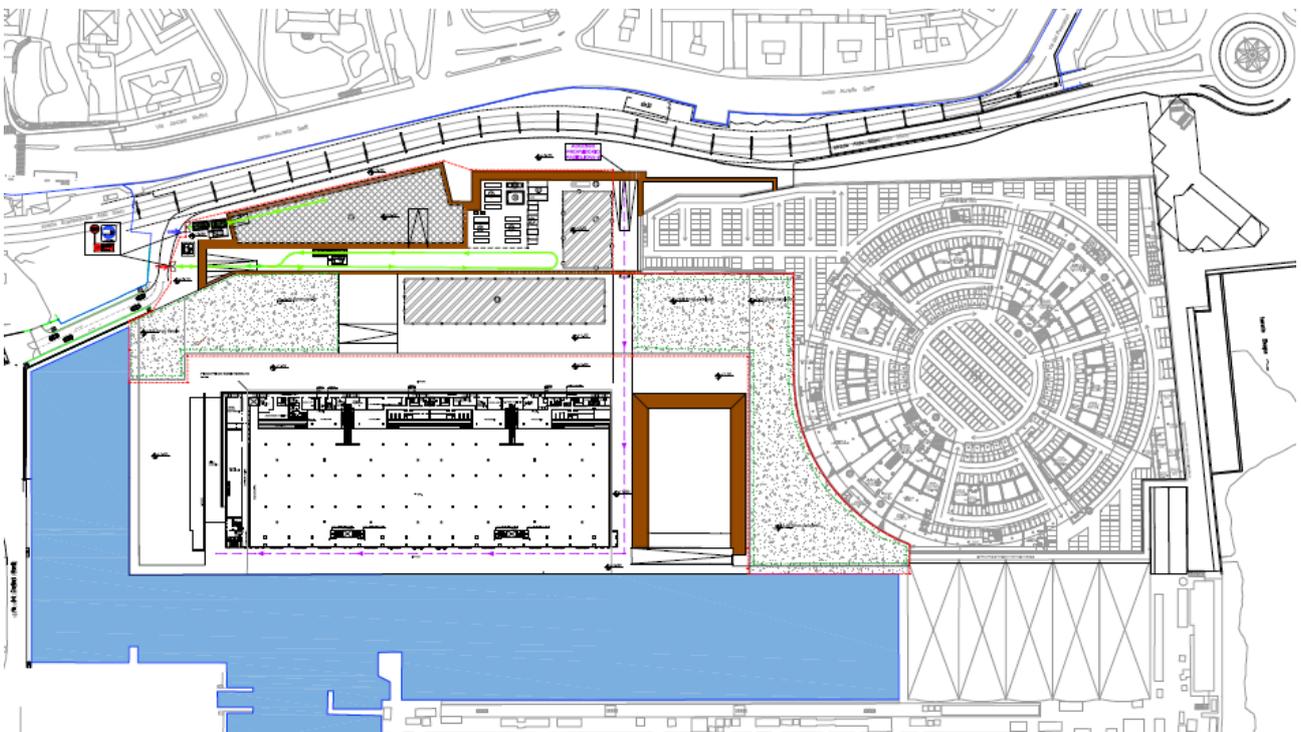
Planimetria di cantiere – Sottofase iniziale
